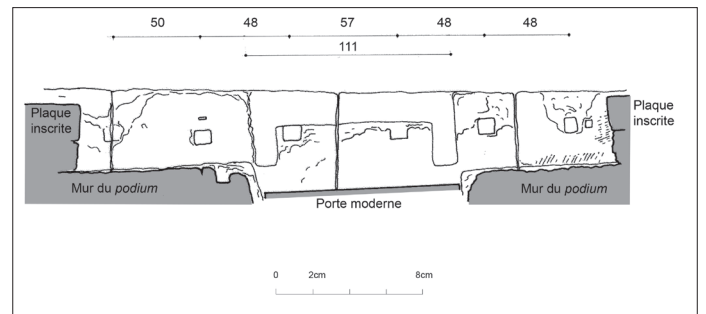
Plan du seuil d'une porte au Sud-Est.
